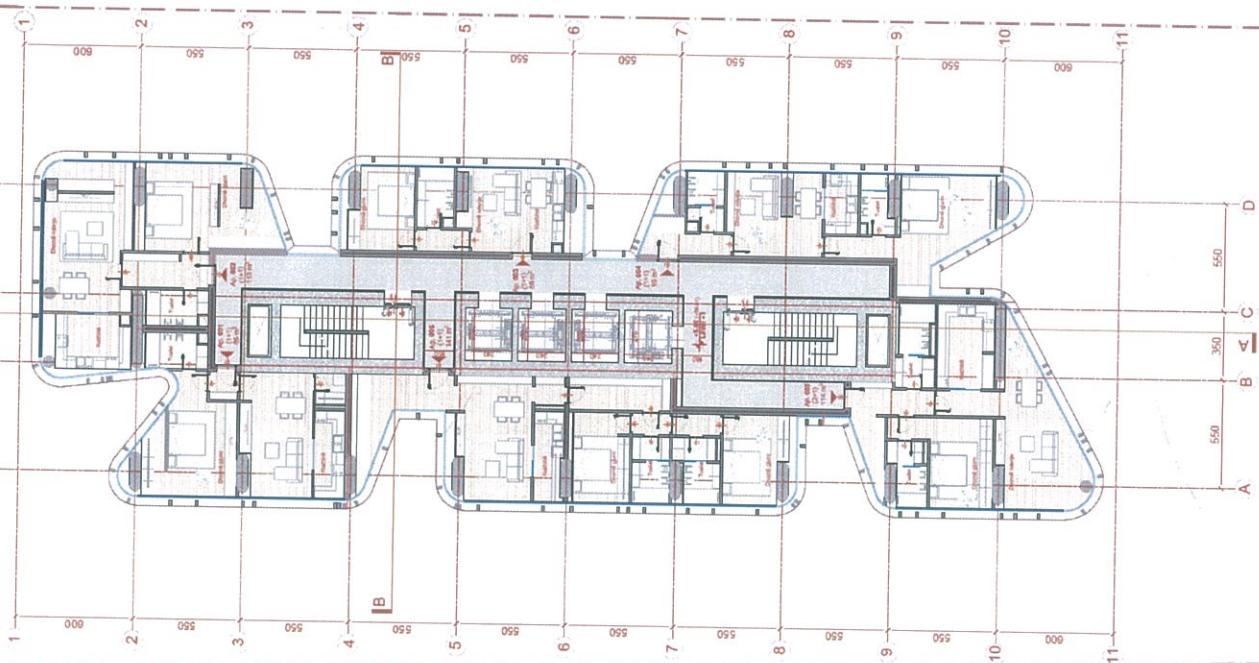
Planimetri e katit tē parë (Apart-Hotel).
